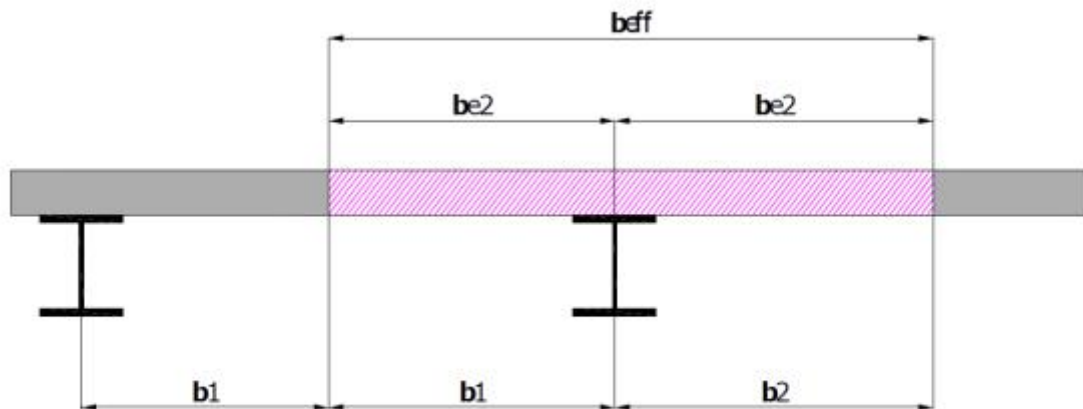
Largeur participante de la dalle dans le cas d'une poutre sur deux appuis.
